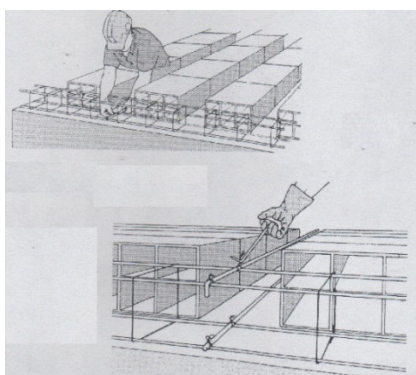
Colocación de fierros en viguetas (SENCICO 2000)
